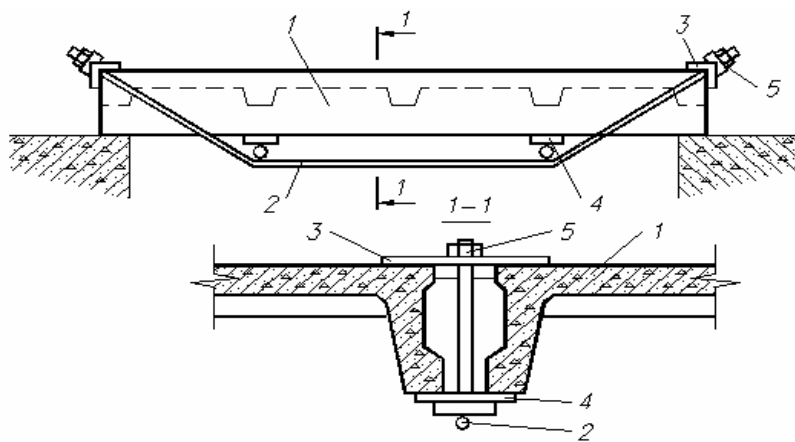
Усиление сборных плит шпренгельной затяжкой в швах между плитами: 1 – усиливаемая конструкция, 2 – затяжка, 3 – уголок, 4 – подкладка-упор, 5 – гайка
